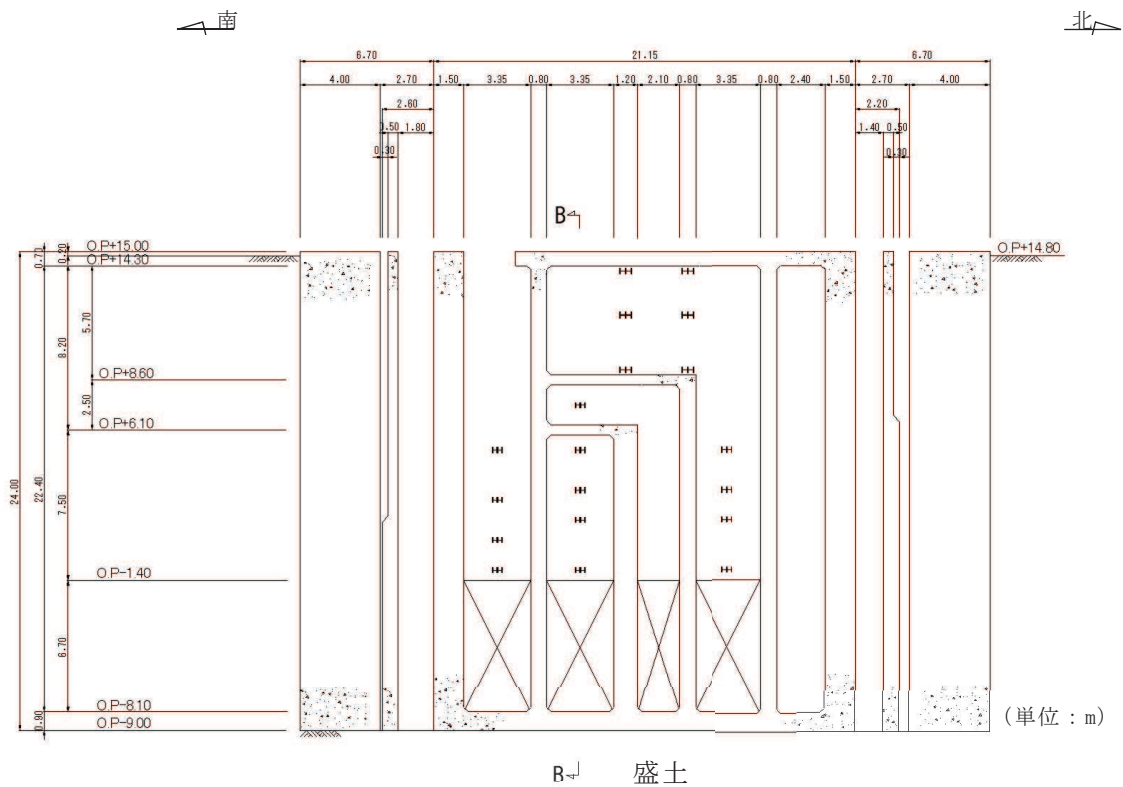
原子炉機器冷却海水配管ダクト（鉛直部）平面図
